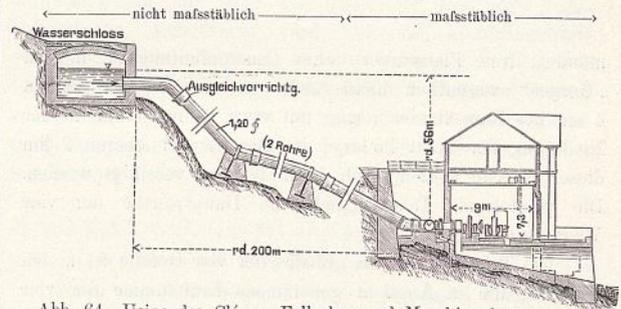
Usine des Clées. Fallrohre und Maschinenhaus.
